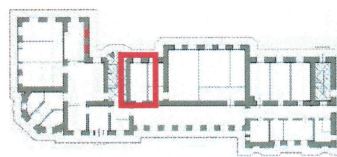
Междуэтажные плоские перекрытия, кирпичные перемычки оконных, проемов
